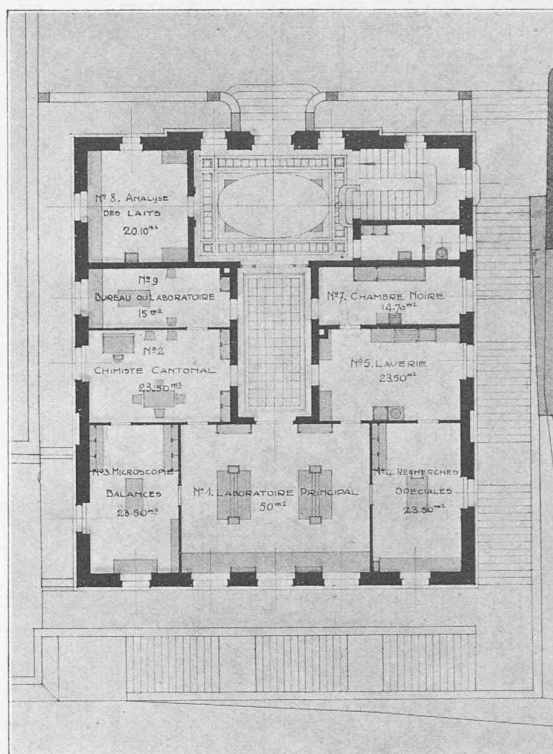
Plan du rez-de-chaussée supérieur. — 1 : 300.
